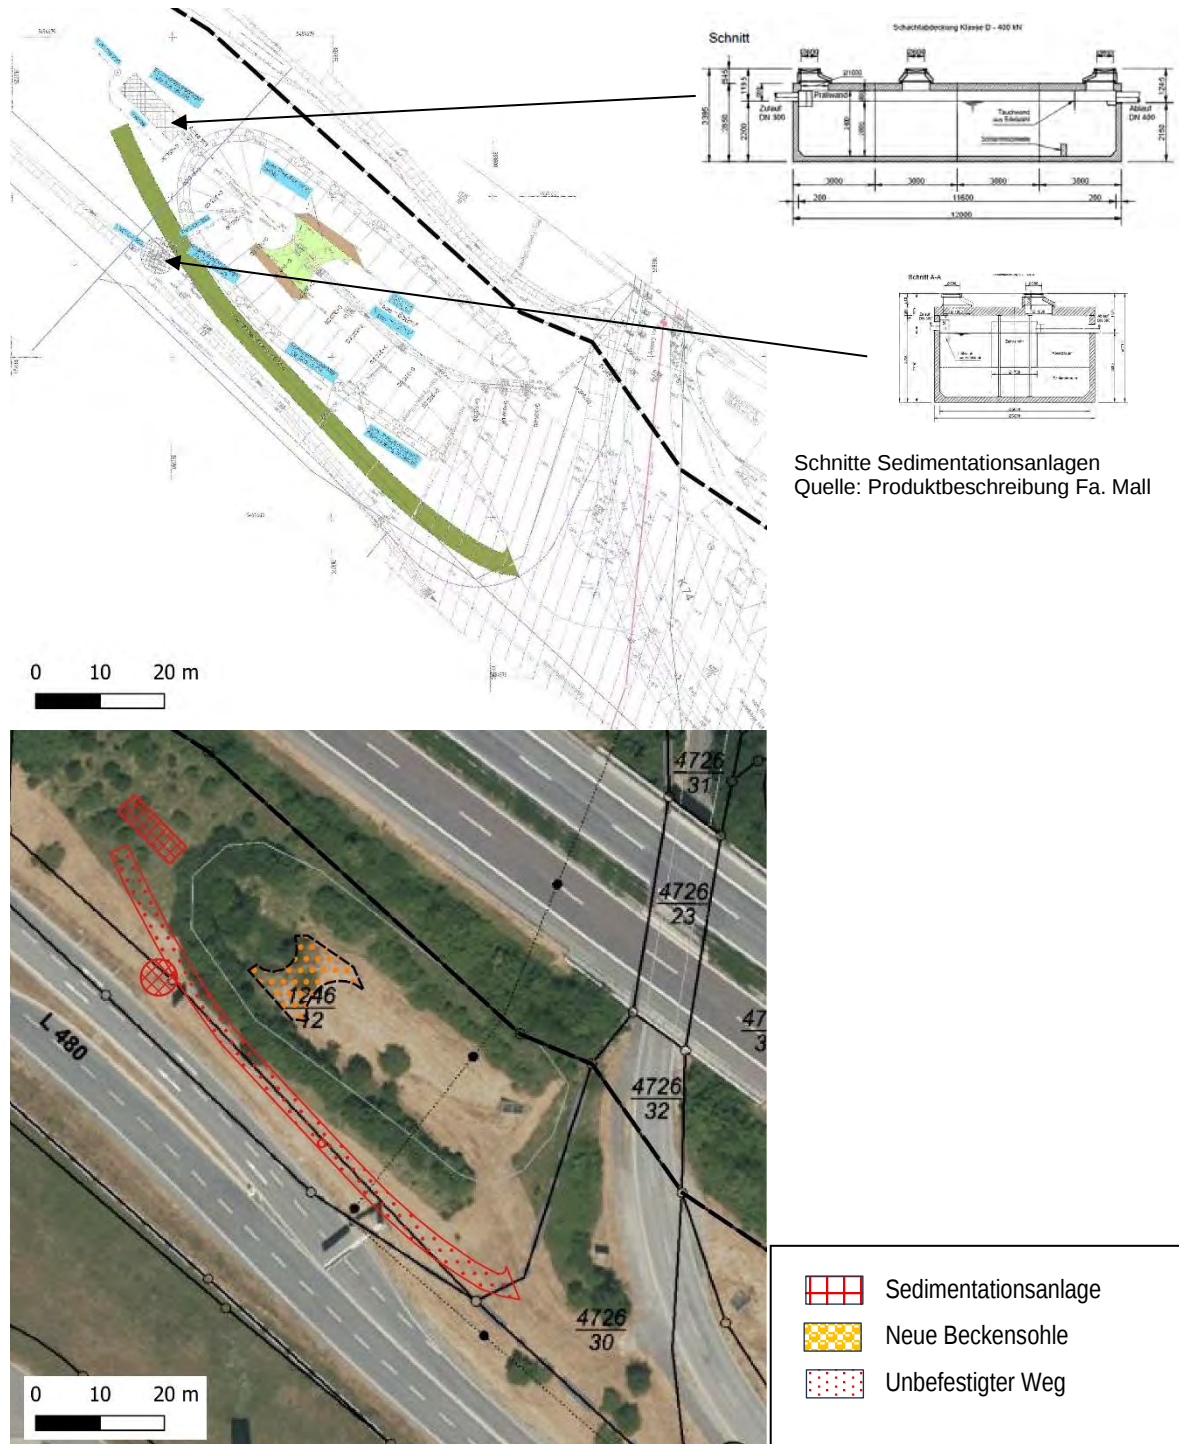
Lageplan Umbau Knoten Süd AS Contwig Becken Genehmigungsplanung Büro
